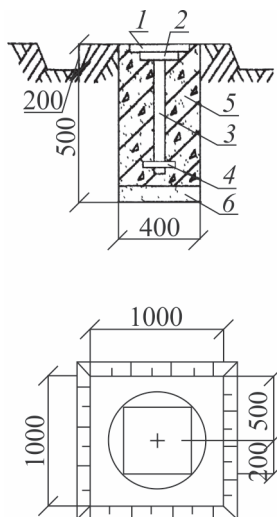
Закрепление основных или главных разбивочных осей здания свыше 5 этажей, сооружения высотой свыше 15 м с продолжительностью строительства до 0,5 года: 1 – деревянная крышка; 2 – металлическая пластина размером 200×200×10 мм; 3 – металлическая труба, $d = 30$ мм; 4 – якорь; 5 – бетон класса В7,5; 6 – песок
